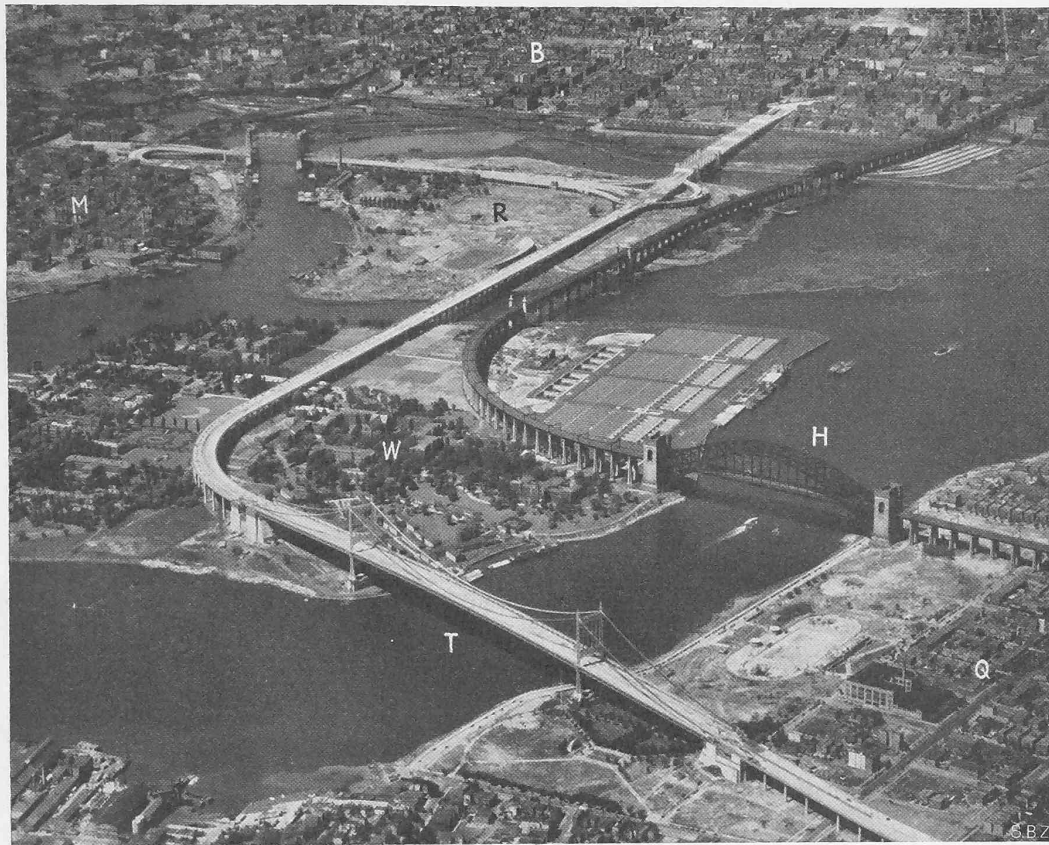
Triborough Bridge in New York. Flugbild aus Süden. — Phot. Mc Laughlin Aerial Surveys.
